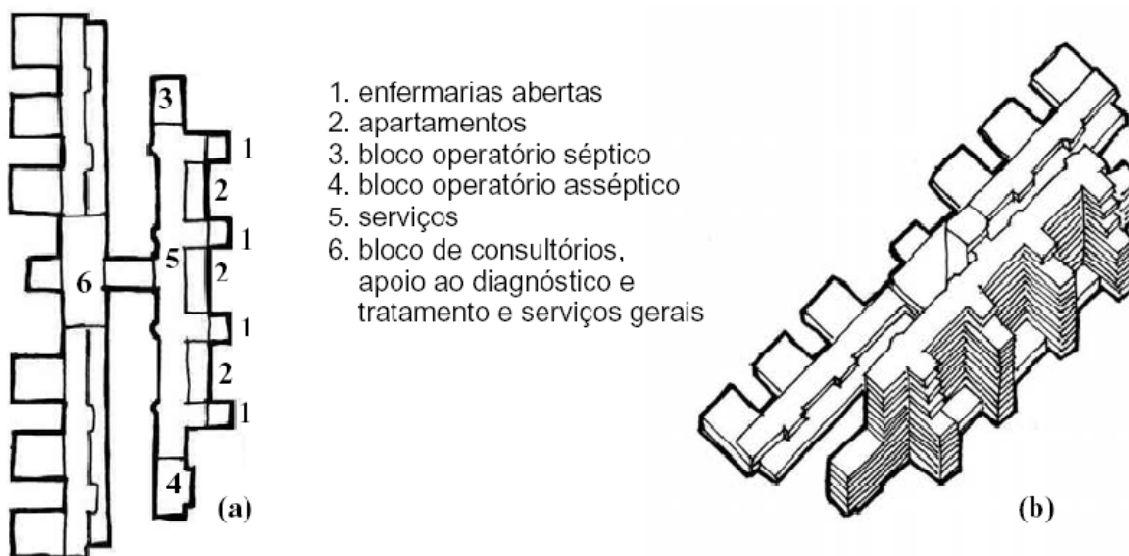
Hospital Beaujon, Clichy, 1935. (a) planta; (b) croqui..
